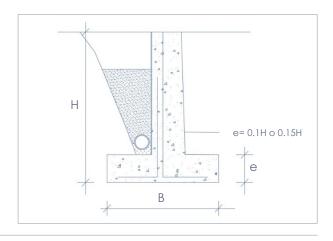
Detalle de muro de contención Fuente: Elaboración propia
